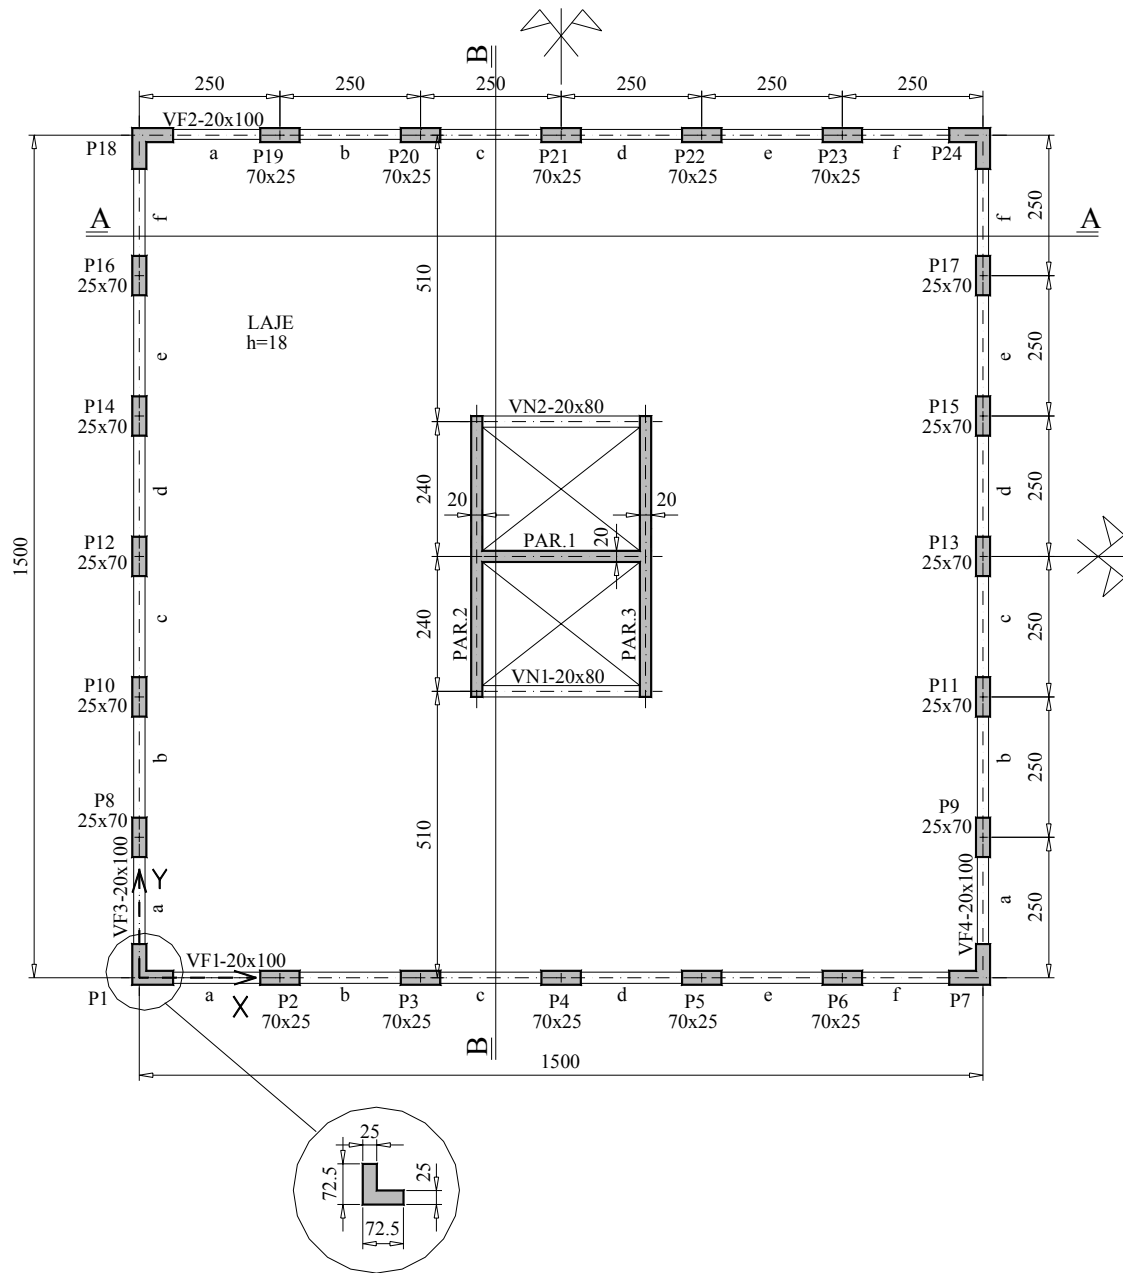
Planta do 16° ao 20° andar (cotas em centímetros)
